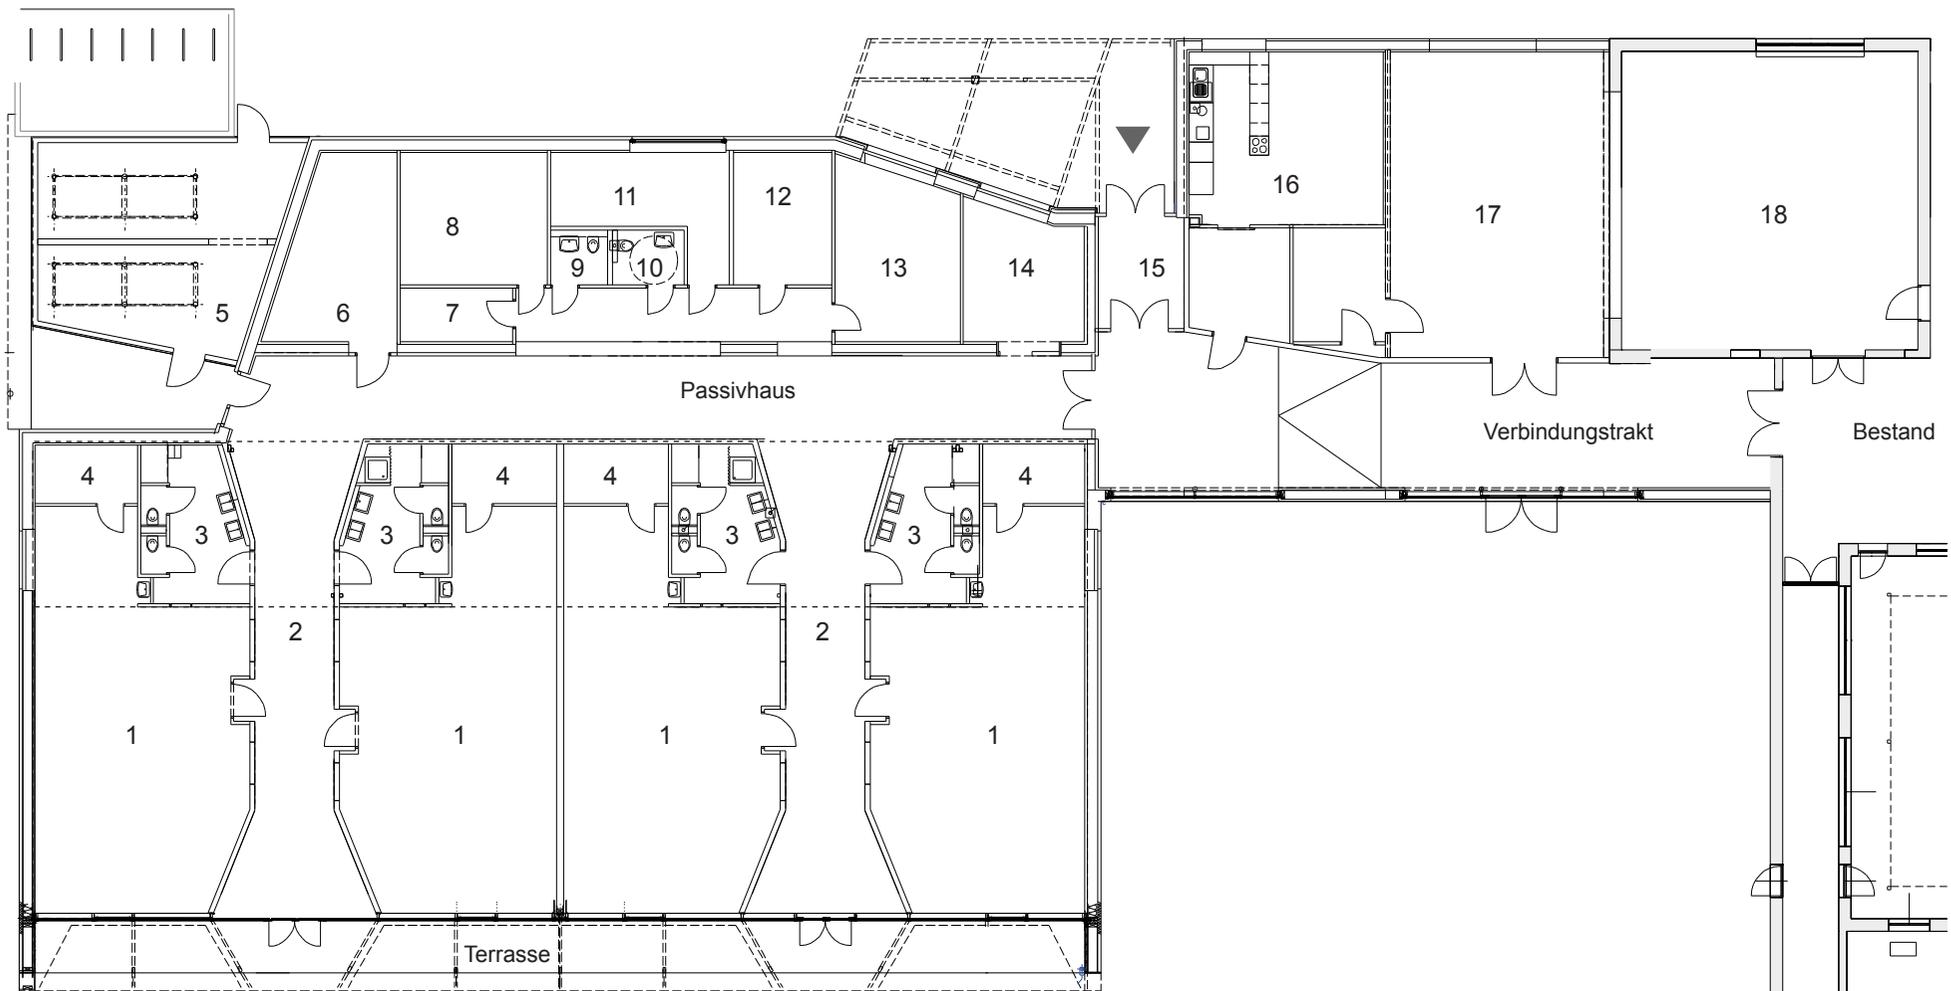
Grundriss KIGA Frauenfeld, Schwechat
